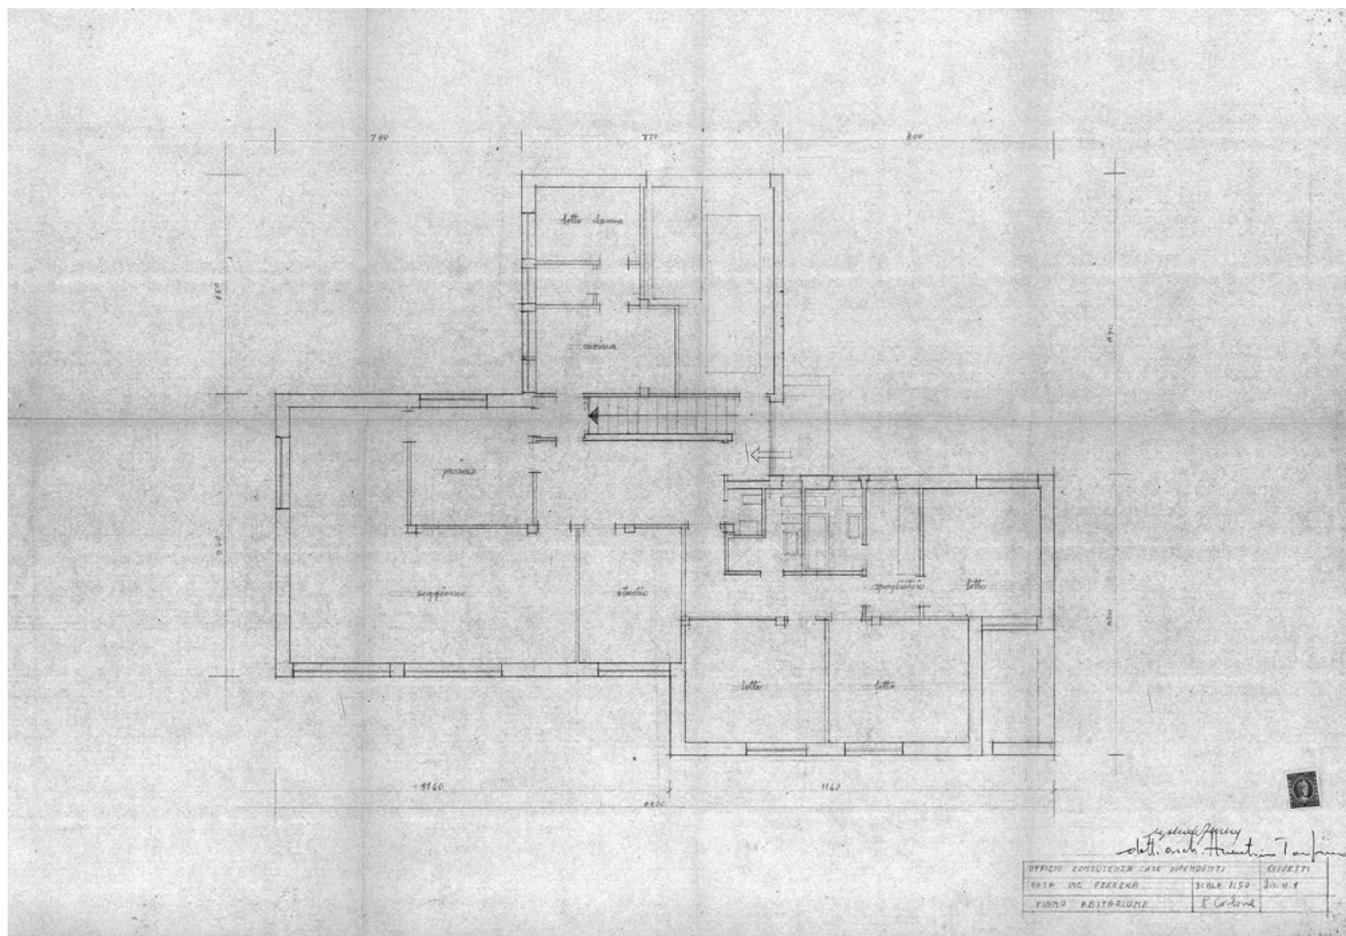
Villa Ferrera-Rocchetta, pianta del primo progetto (Archivio Edilizio Comune di Banchette).
